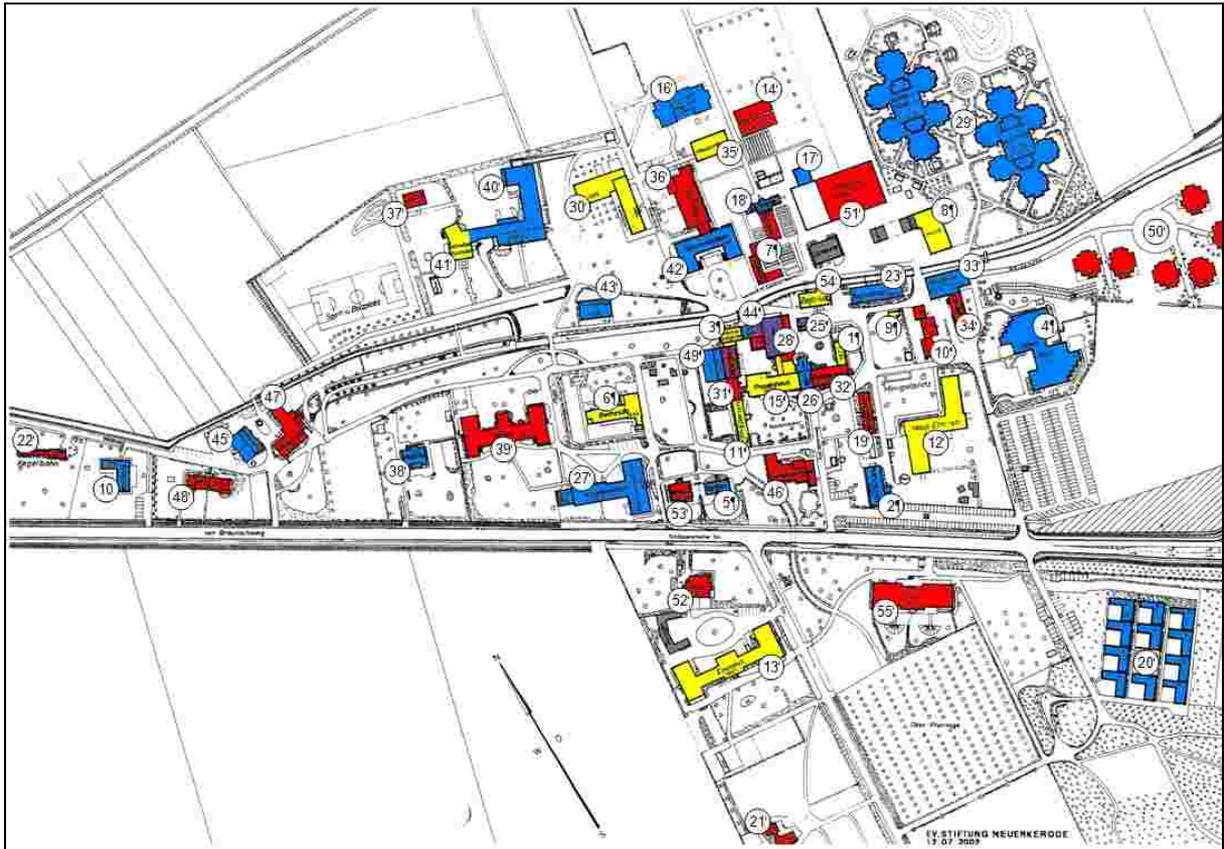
Liegenschaftsplan mit Gebäudenummerierung
